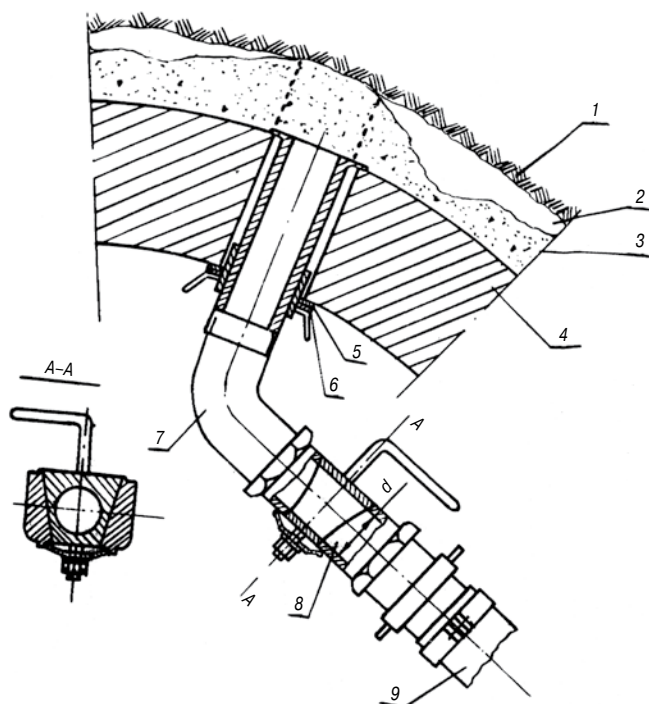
Схема нагнетания тампонажного состава за фундаментную кладку: 1 – порода; 2 – неуплотненная полость; 3 – тампонажный состав; 4 – фундаментная кладка; 5 – резиновая прокладка; 6 – муфта; 7 – патрубков; 8 – пробковый кран; 9 – тканевый шланг
